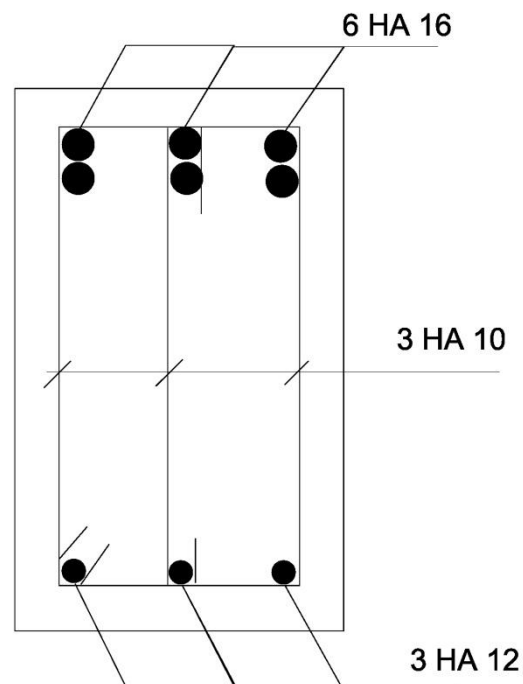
Coupe transversale sur l'appui de la poutre.
